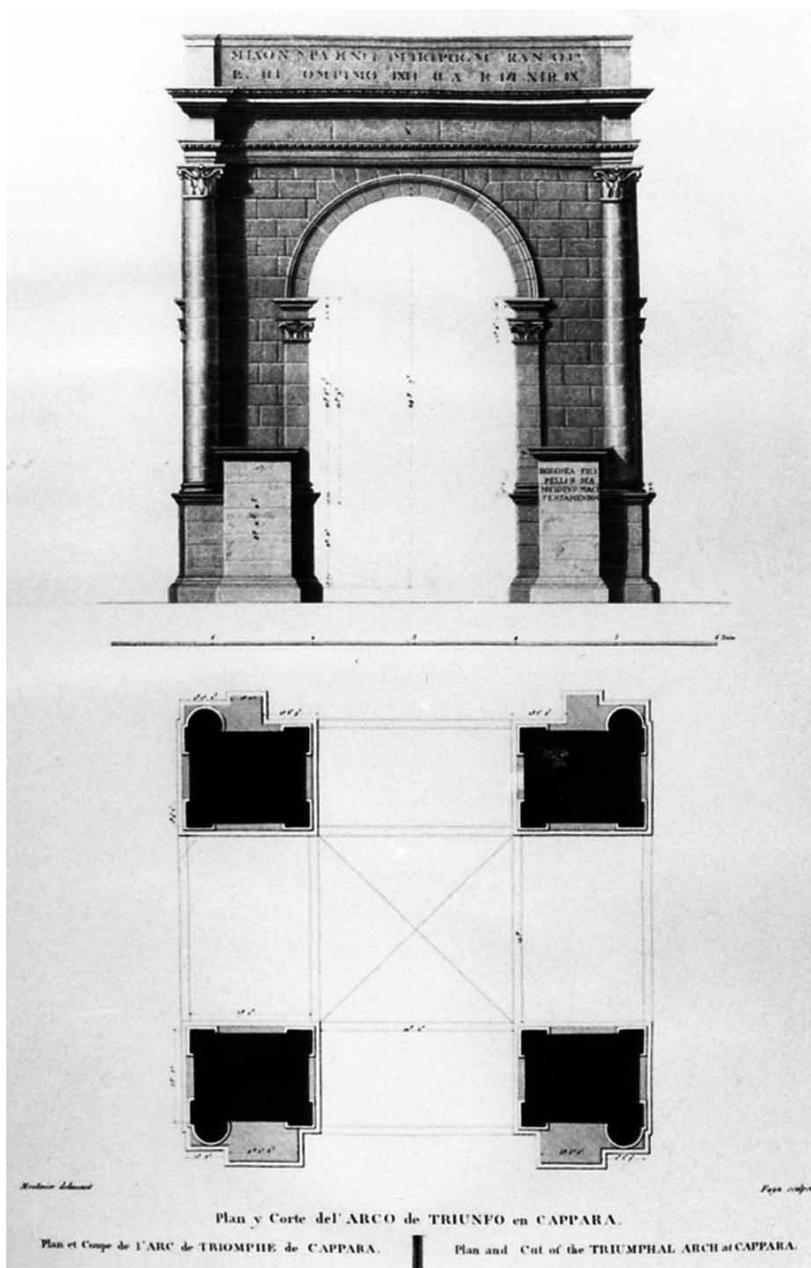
Reconstrucción y planta del tetrapylon de Laborde.
